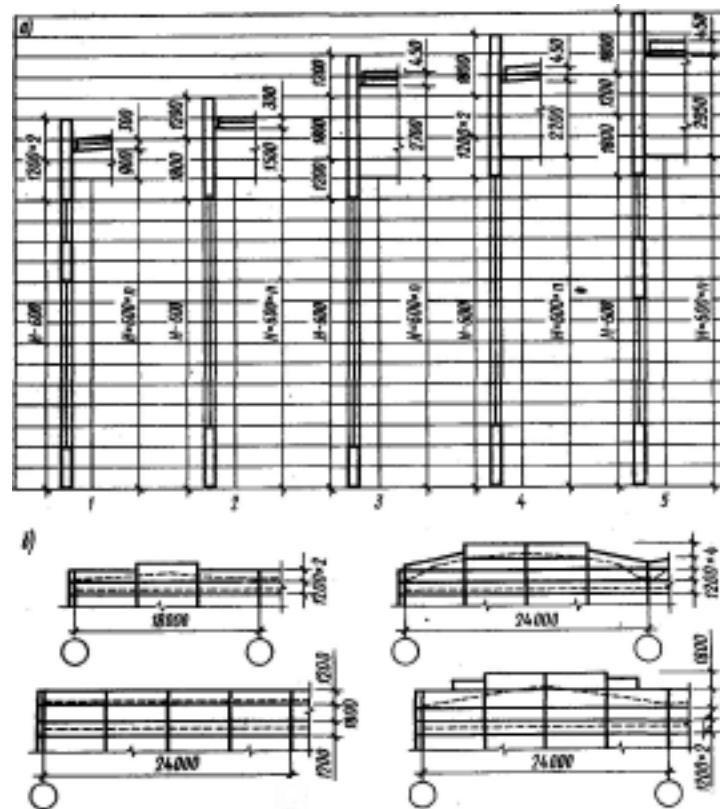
Схема раскладки панелей стен одноэтажных зданий:
